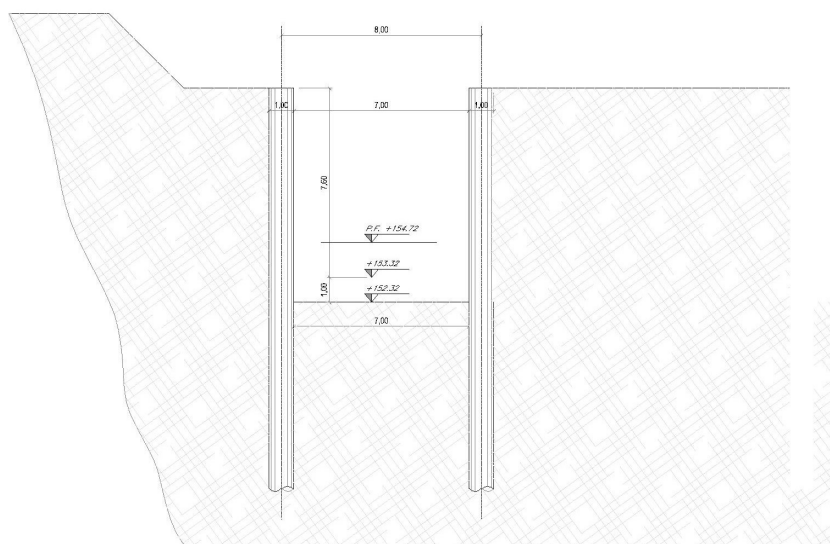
Sezione del manufatto oggetto della presente relazione di calcolo.
